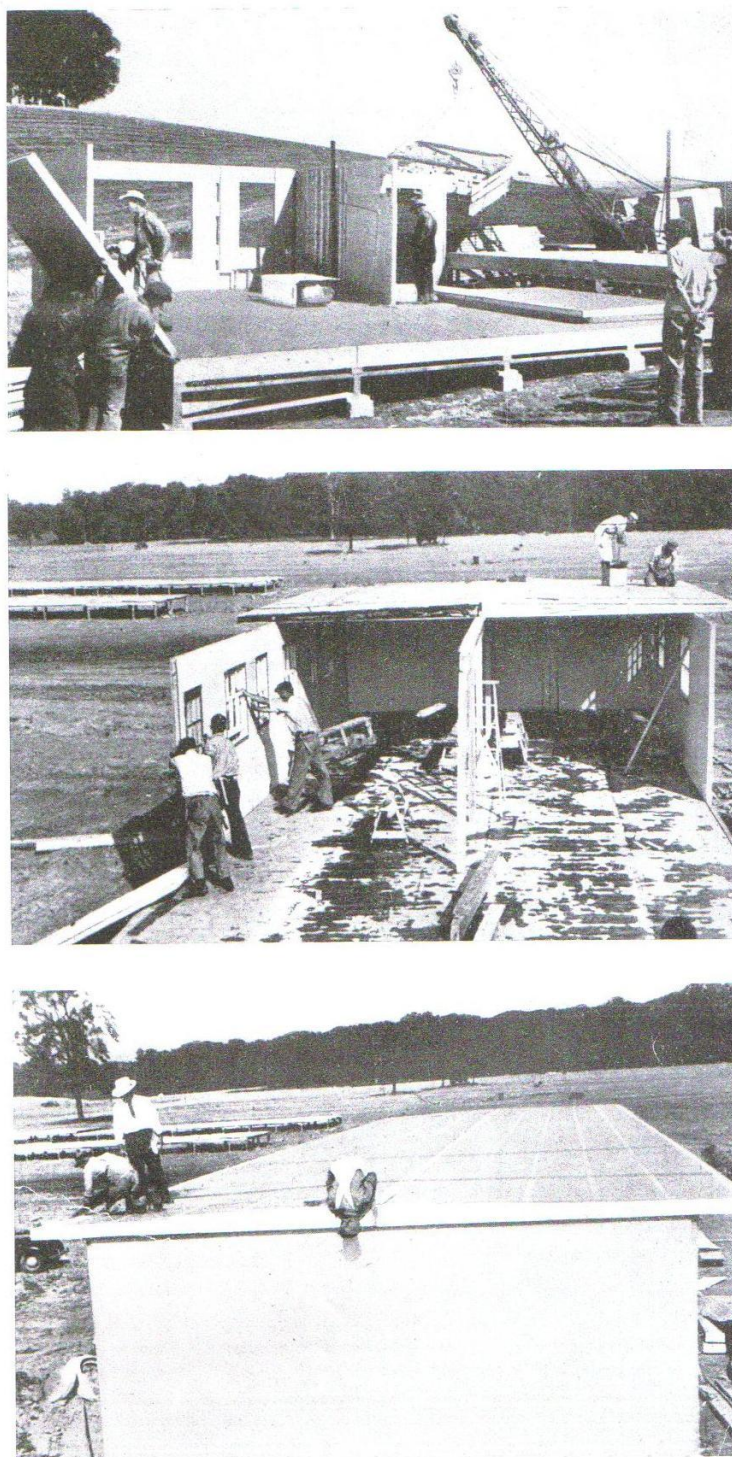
, lavoro di montaggio di una costruzione prefabbricata.
